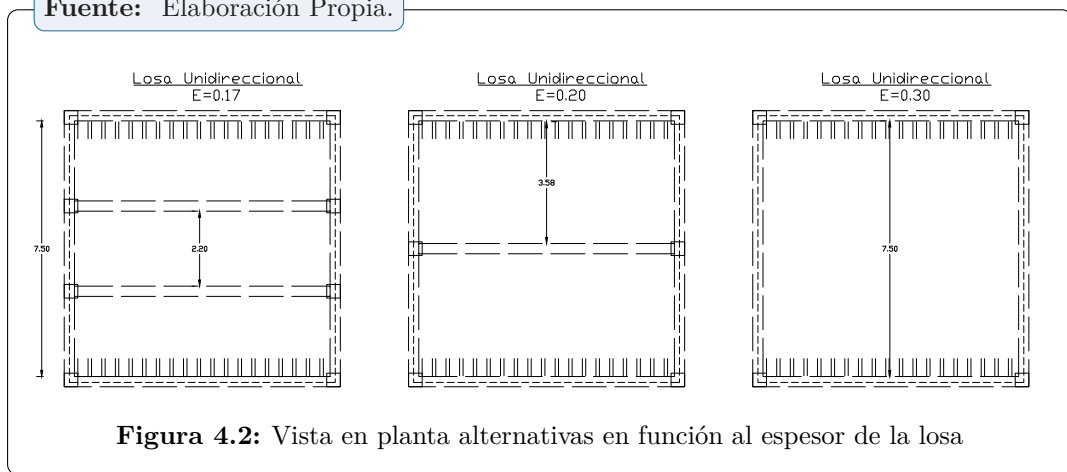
Vista en planta alternativas en función al espesor de la losa
